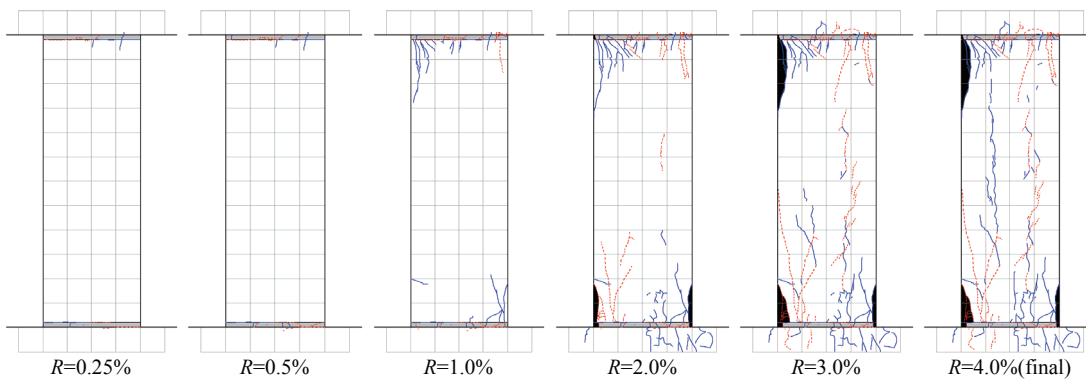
U1/3-0.1 ひび割れ状況
